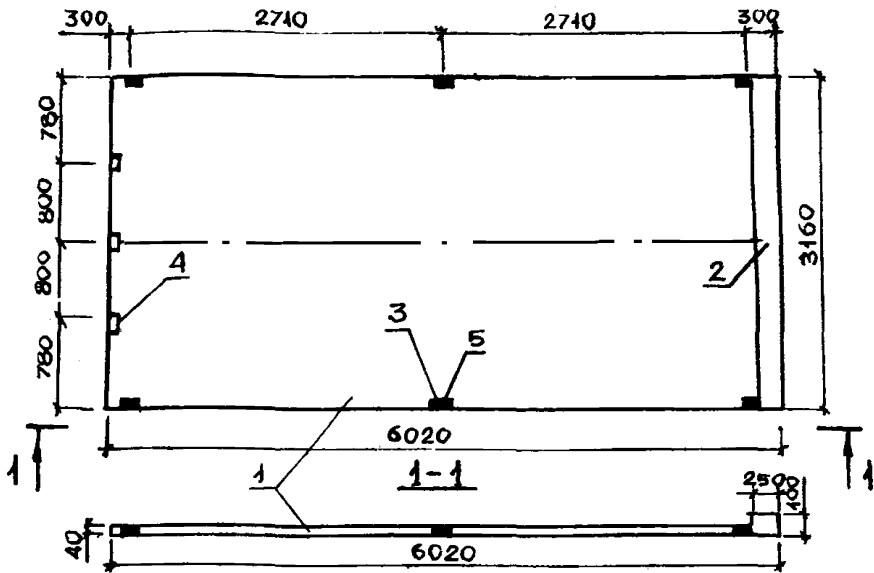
Конструкция предварительно напряженной гибкой пластины с совмещенными соединительными и монтажными закладными деталями:
